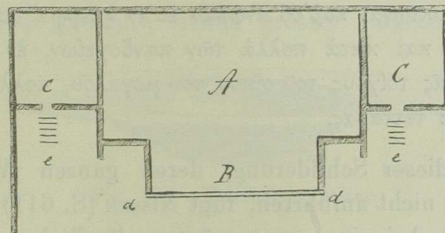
Grundriss eines persischen Hauses nach Dr. POLAK.
